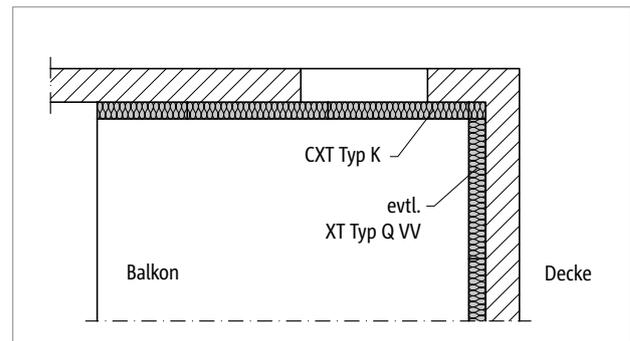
Schöck Isokorb® CXT Typ K, XT Typ Q-VV: Balkon bei Inneneck, zwei-seitig aufliegend
